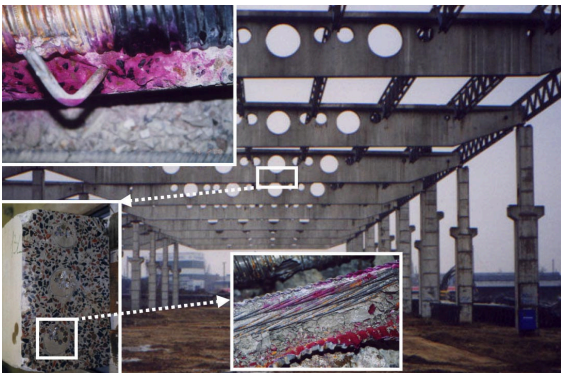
Zerstörende Bauteiluntersuchungen an Spannbetonbindern einer Halle [I. 19]
